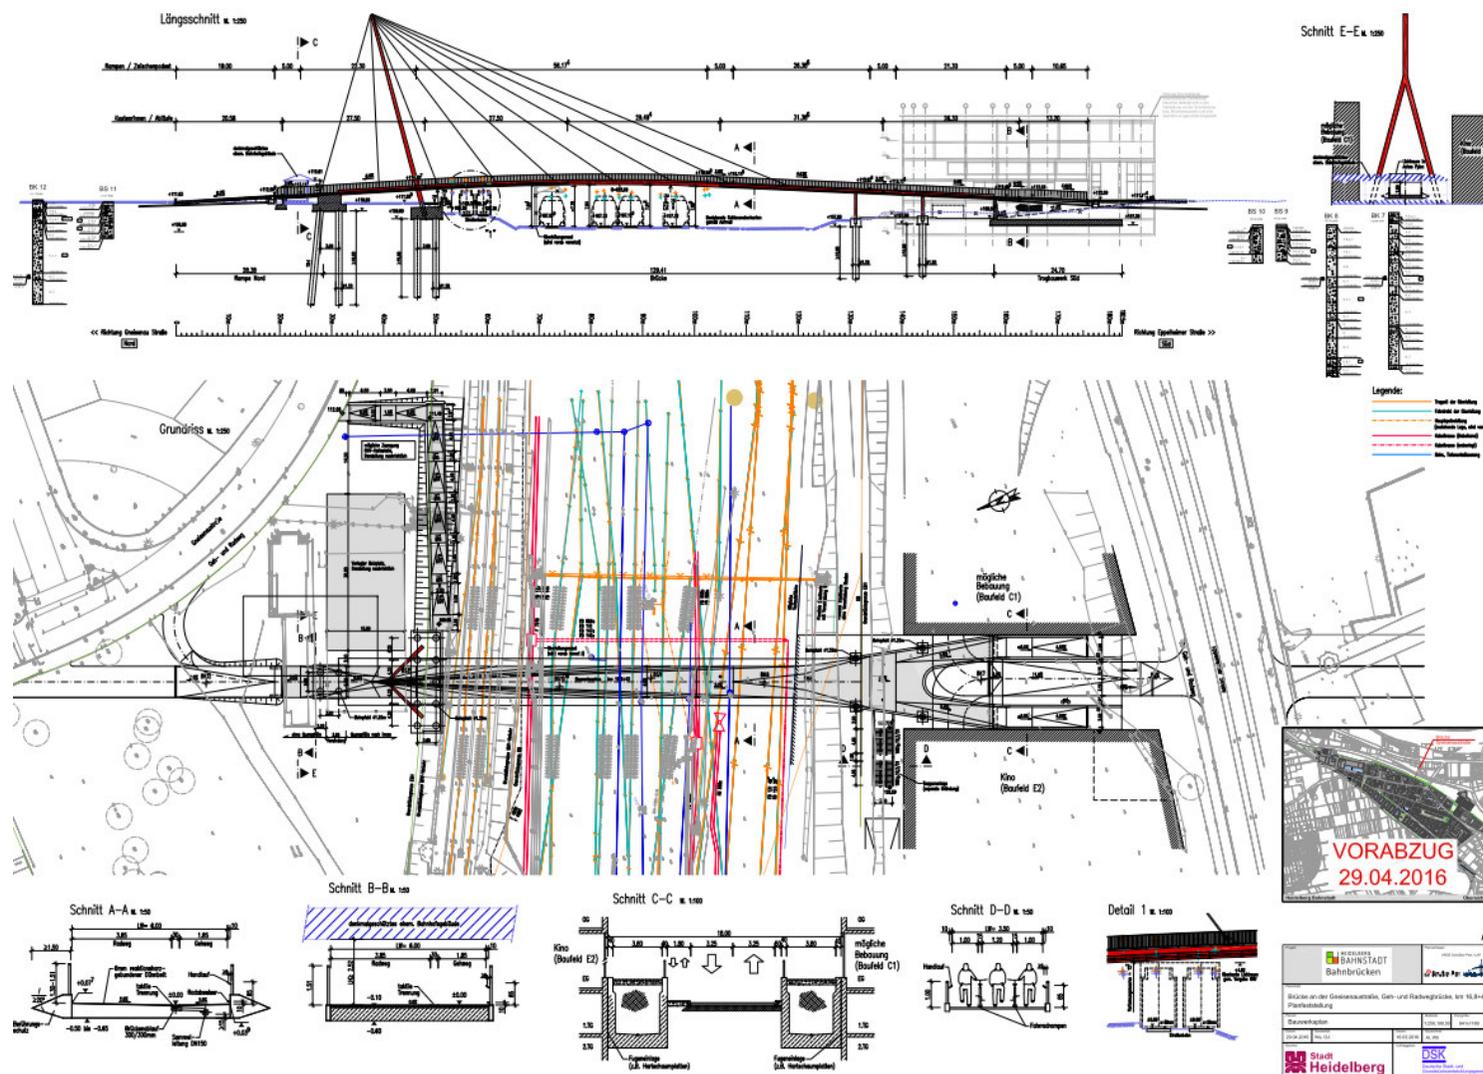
Bauwerksplan „Brücke an der Gneisenaustraße“
